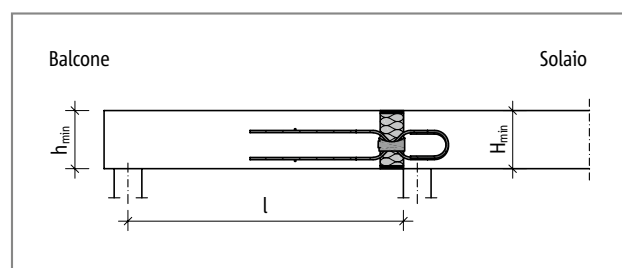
Schöck Isokorb® T tipo QP-VV1 - QP-VV3: sistema statico
